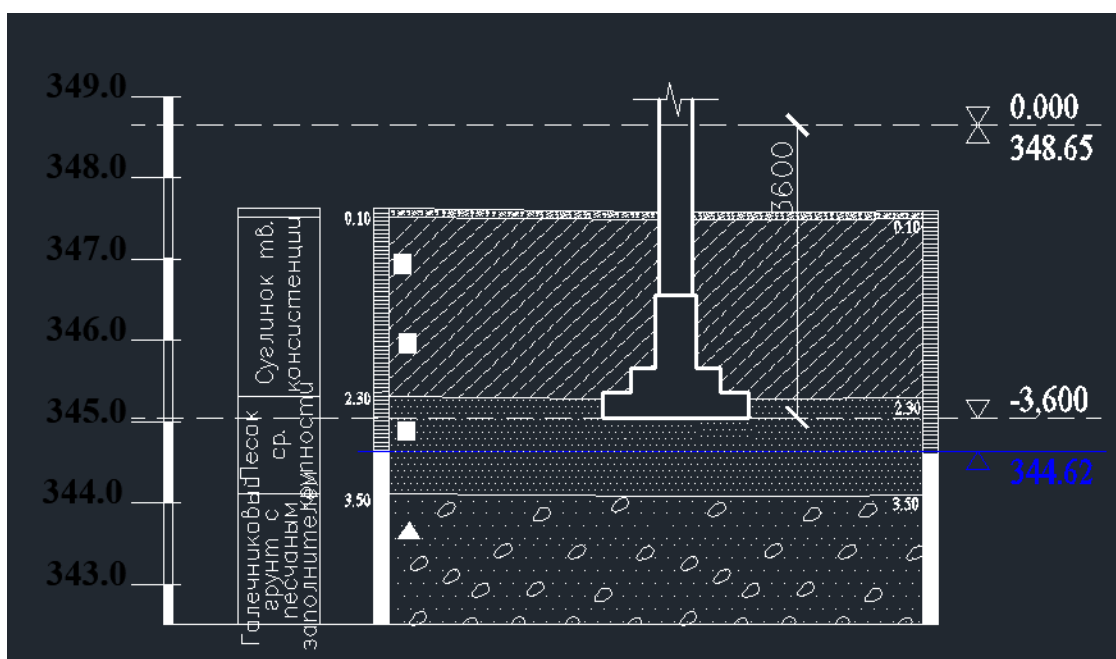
Геолого-литологический разрез строительной площадки
